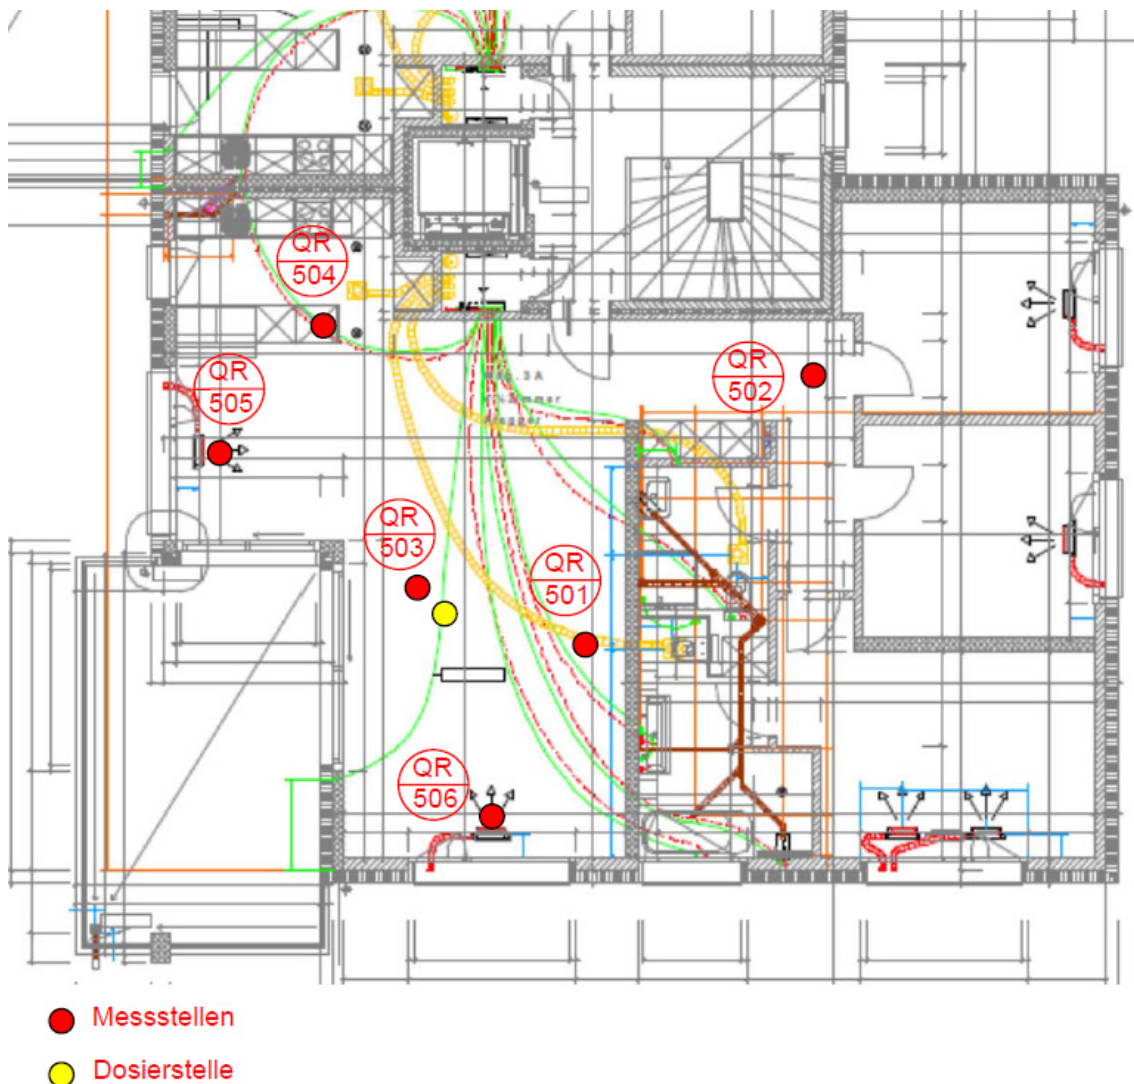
Grundriss 4.5-Zimmer-Wohnung in Malers mit Messstellen der Tracergas-Messung
